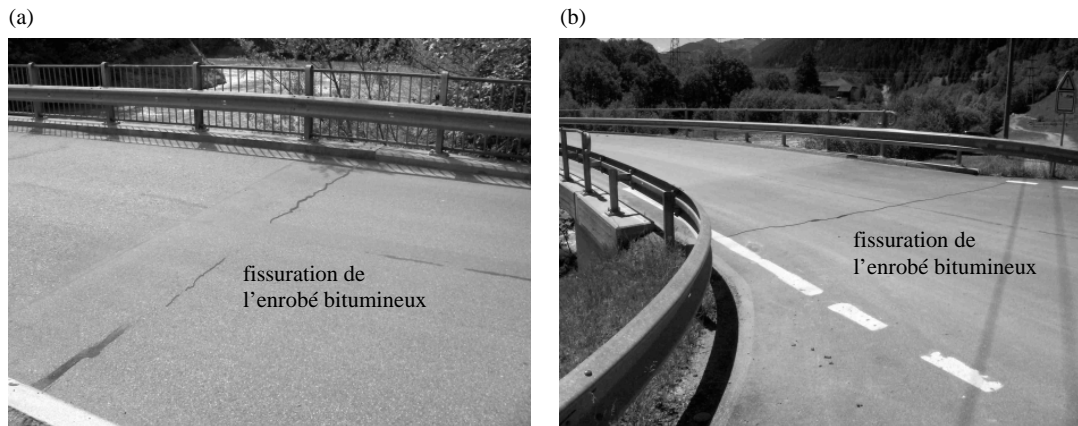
Exemples de fissuration de la surface de roulement au niveau du détail de connexion entre la culée et la dalle de transition [Kaufmann 2009], détails de connexion selon la figure 16 (a) ; (a) Pont semi-intégral de 68 m de longueur construit en 1986 à Reichenau/CH ; (b) Pont semi-intégral de 80 m de longueur construit en 2000 à Cumpadials/CH
